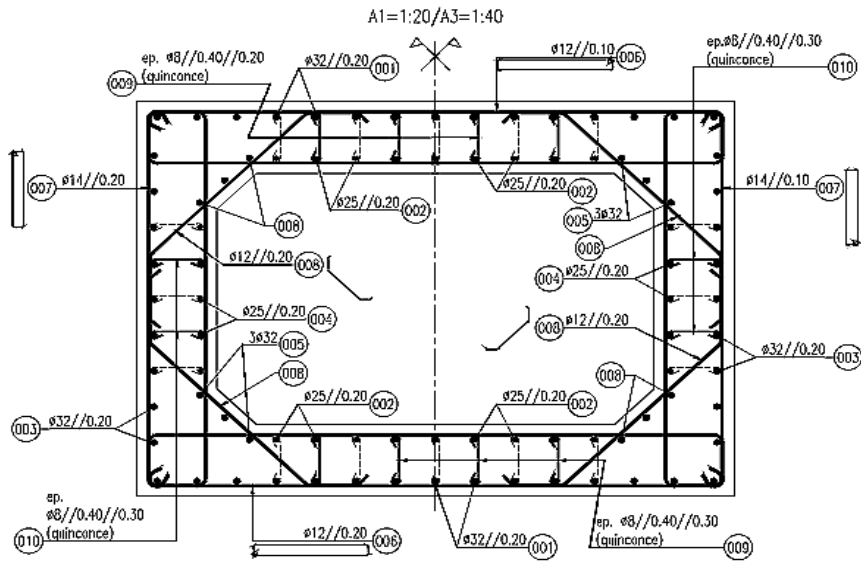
Le ferrailage longitudinal et transversal à la tête et au pied de fût des piles élancées
